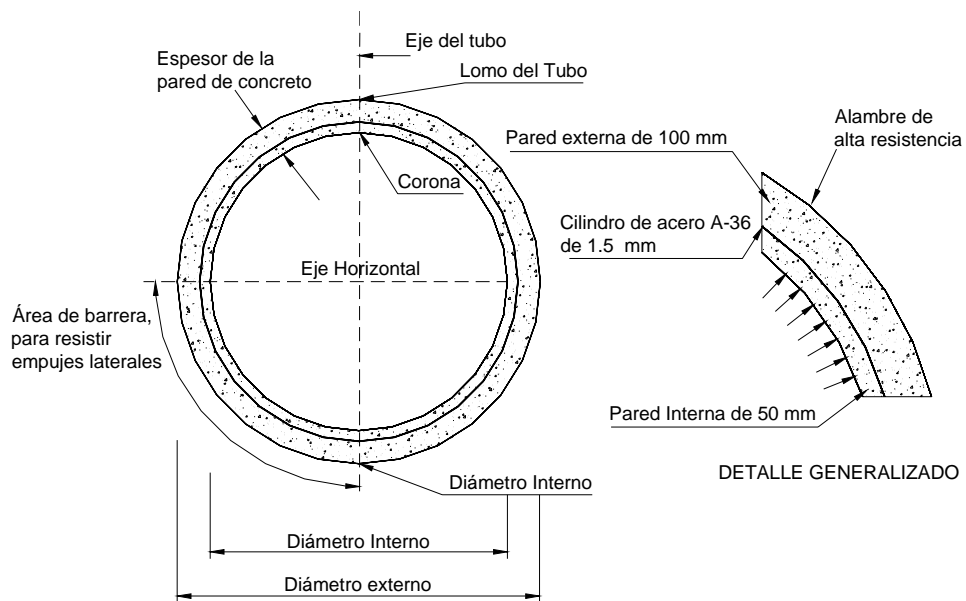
Sección transversal del tubo de concreto presforzado (León, 2004).
